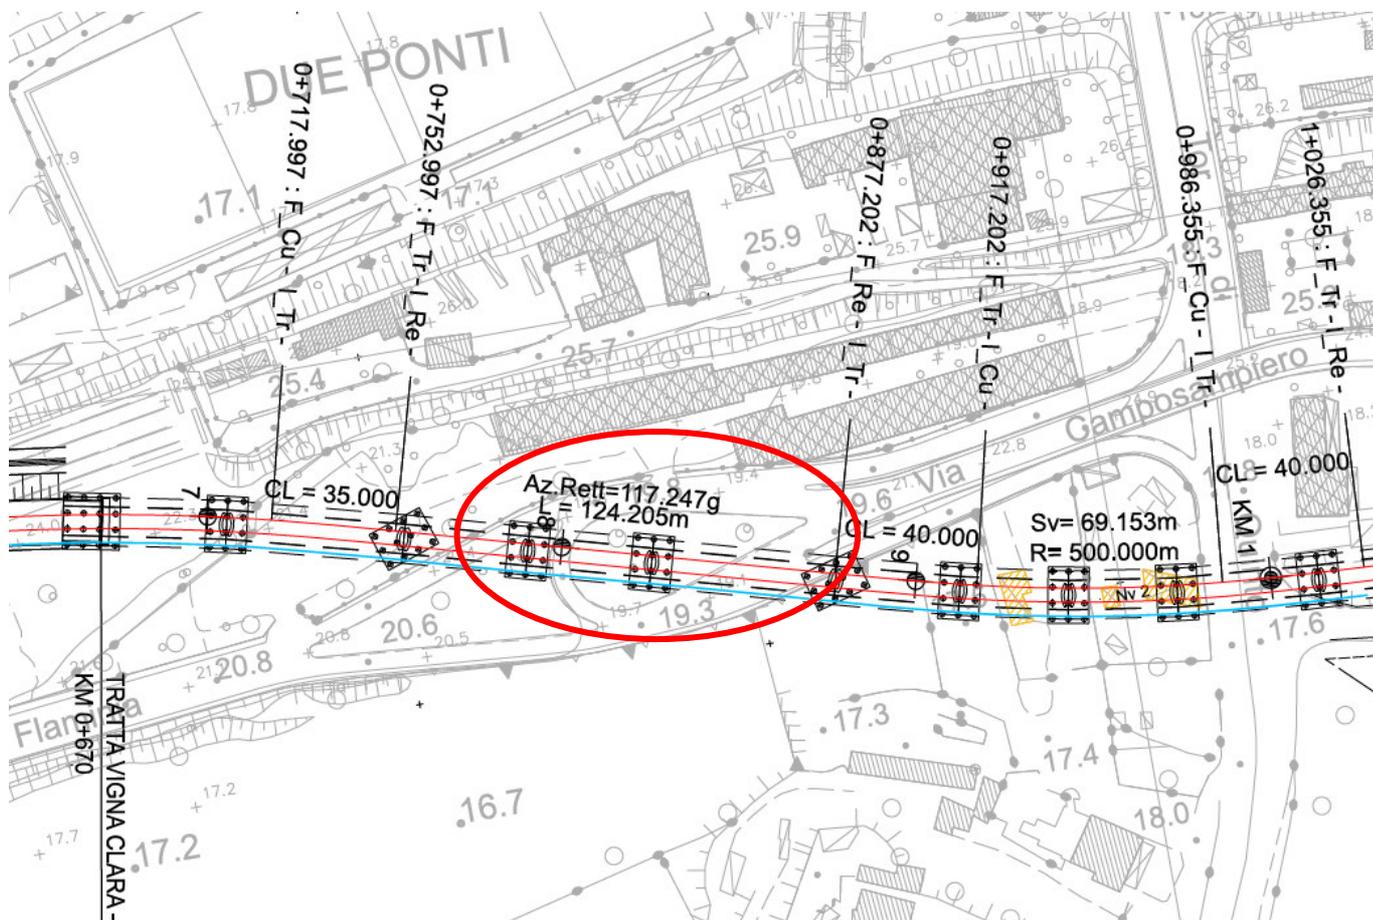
Stralcio planimetrico: intersezione con via Flaminia Vecchia
